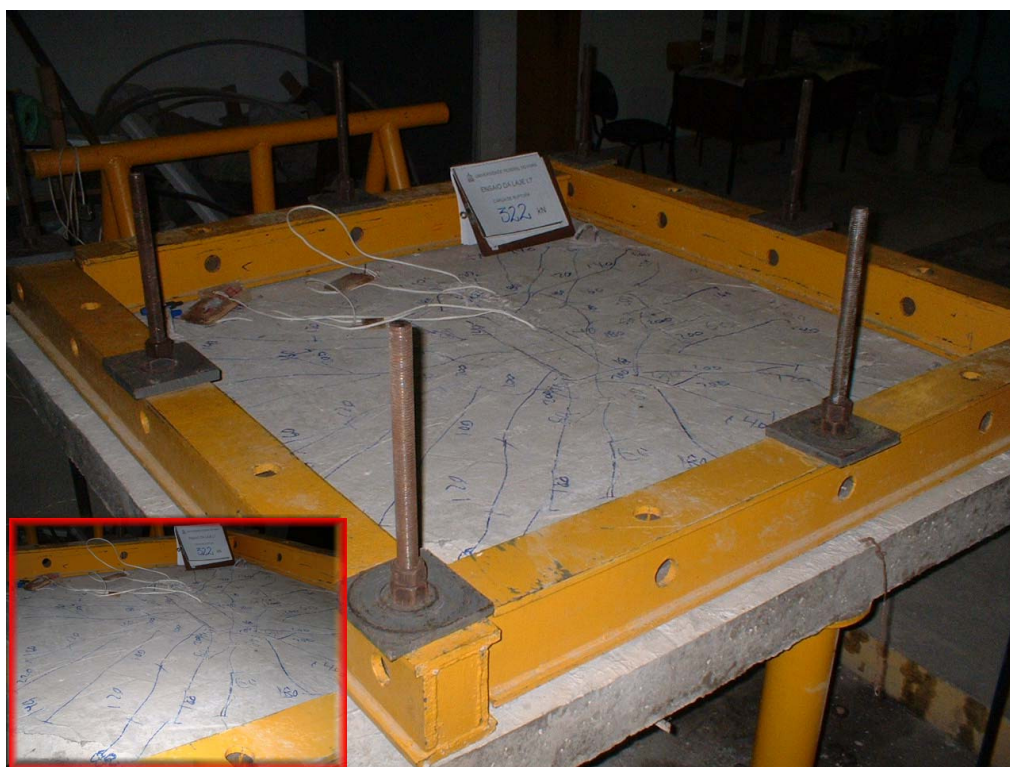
Fissuras desenvolvidas na face superior da laje L7
